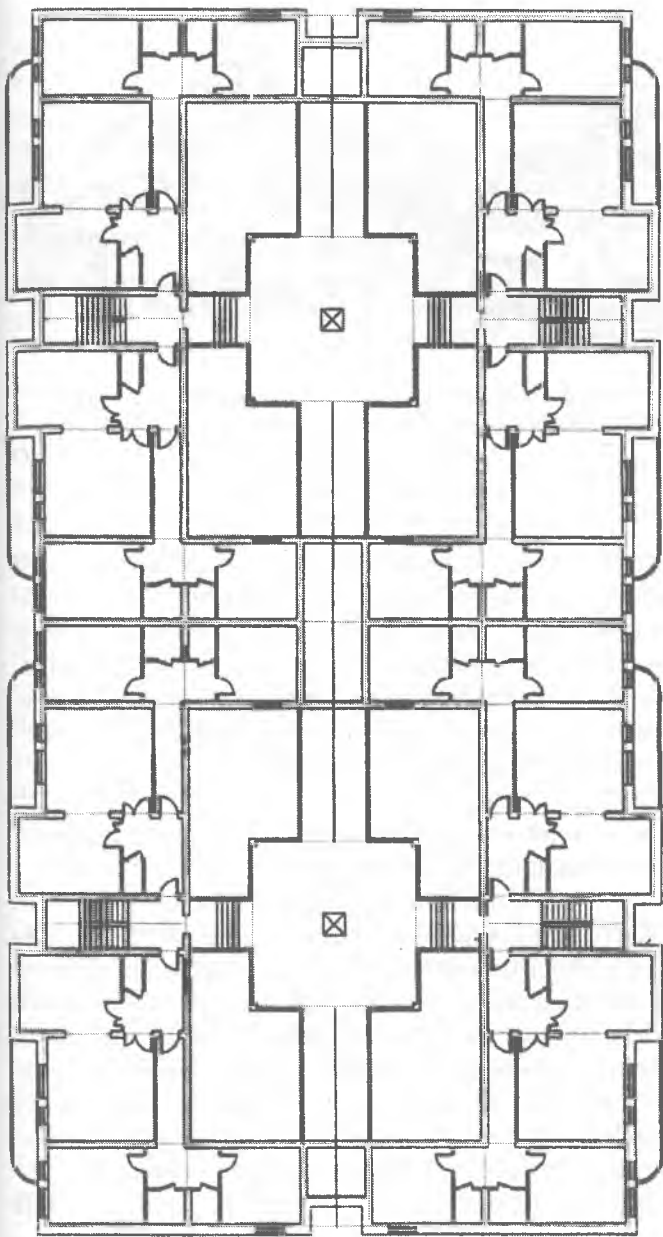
План экспериментального дома «хотонного типа». Блоки из четырех квартир объединяют общий двор со светопрозрачным перекрытием. Во дворе должны располагаться печь или камин, а также зимний сад.
